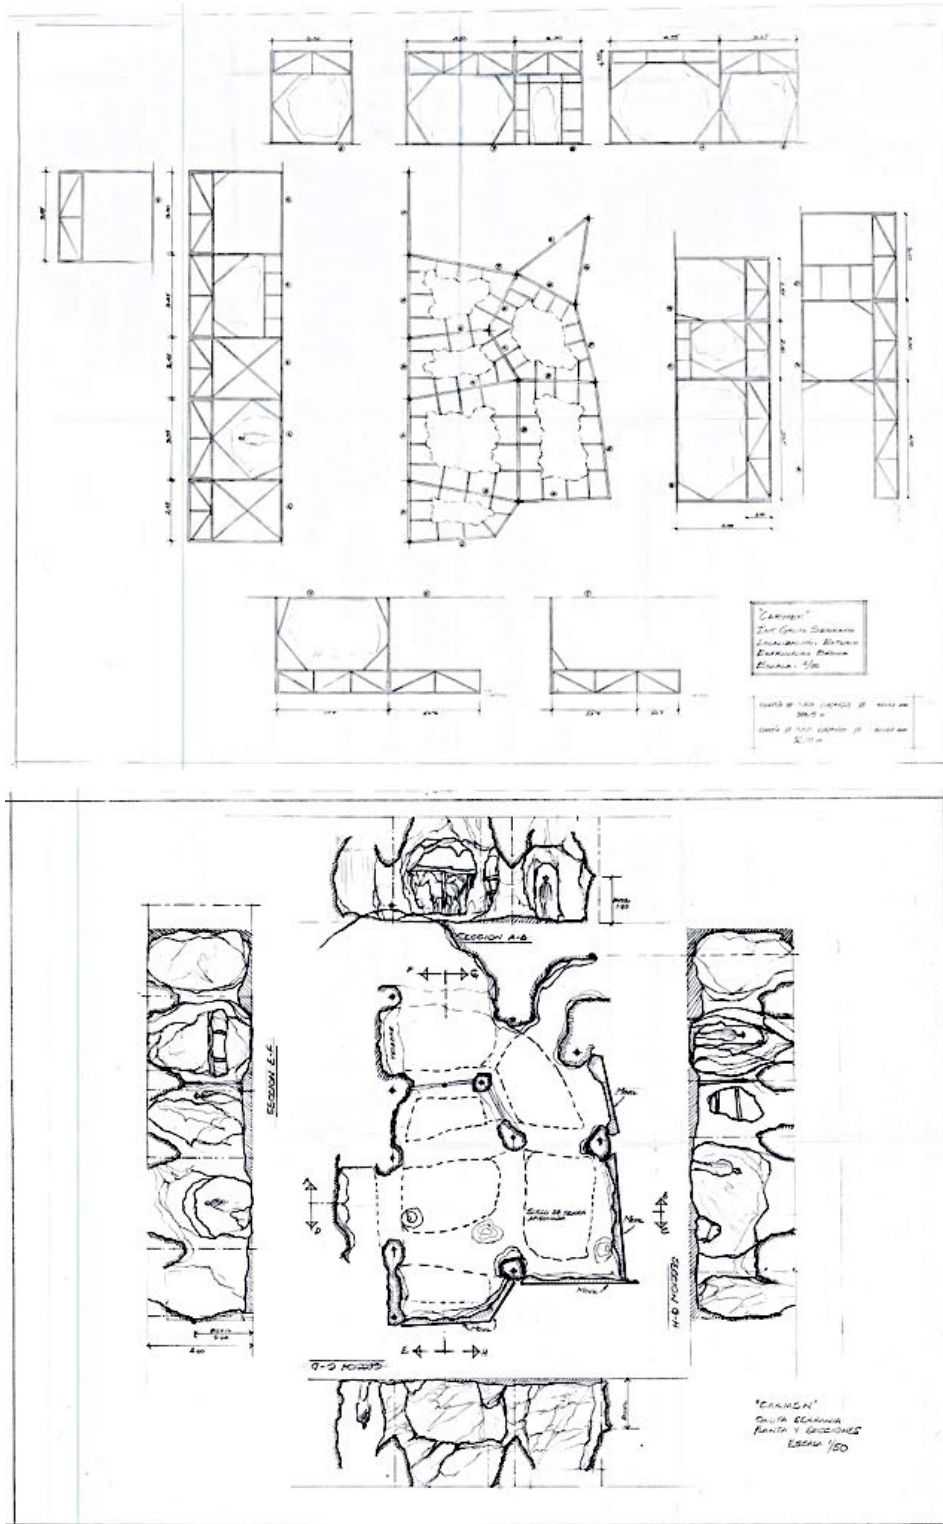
Plano. Planta y alzados de la gruta. *Carmen*.
